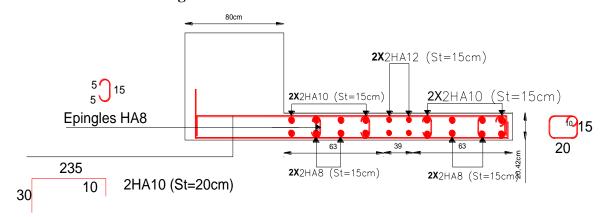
Schéma de ferraillage de voile Vx₆
